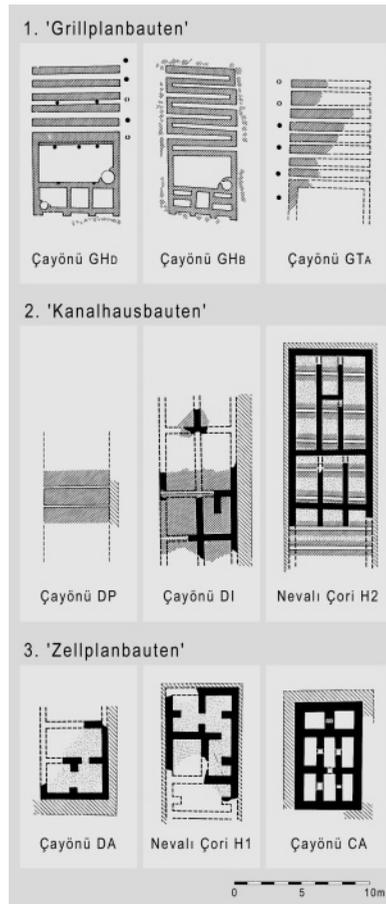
Çayönü und Nevalı Çori, exemplarische Grundrisse von Plantypenbauten aus unterschiedlichen Siedlungsphasen (Abb. nach Schirmer 1988, 369, Abb. 1, Umzeichnung D. Kurapkat).
